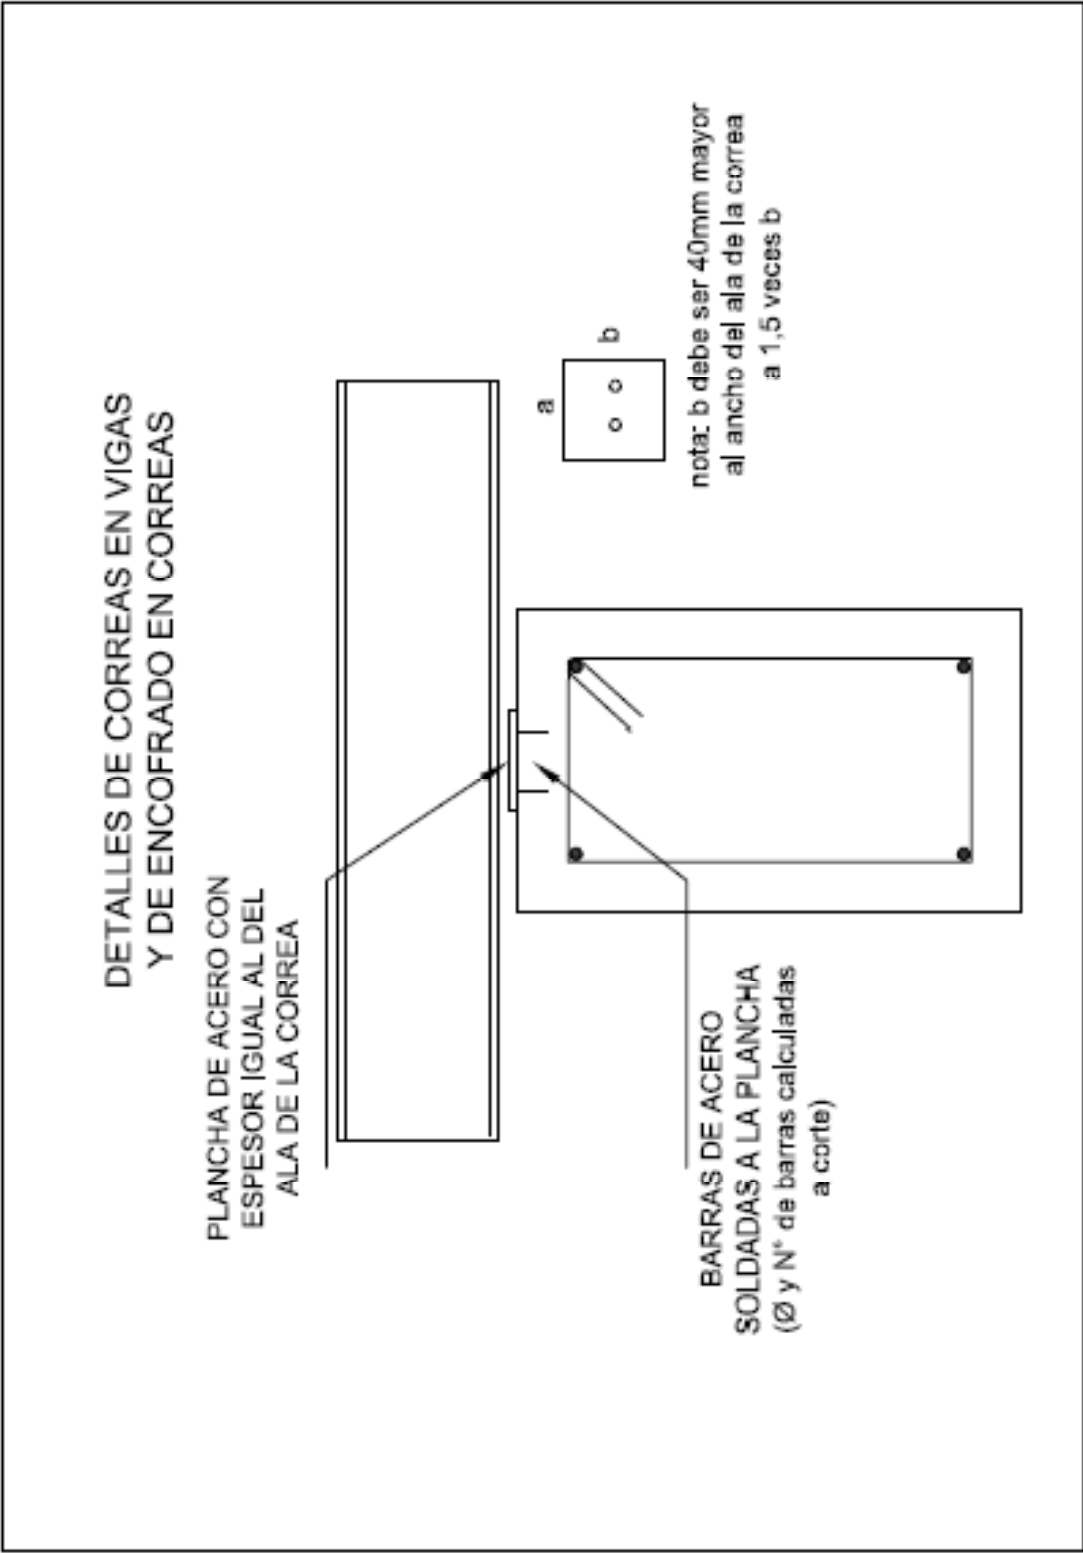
Detalle de apoyo de correa de acero en viga de concreto
